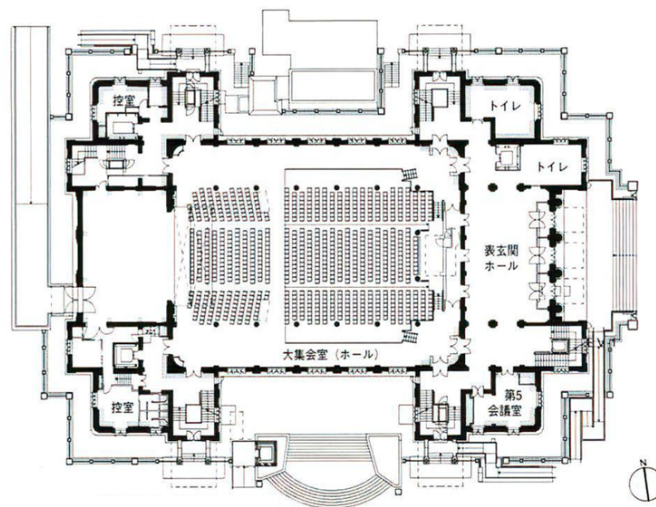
大阪中央公会堂平面図 『新建築』2002 年 12 月号 90P より
